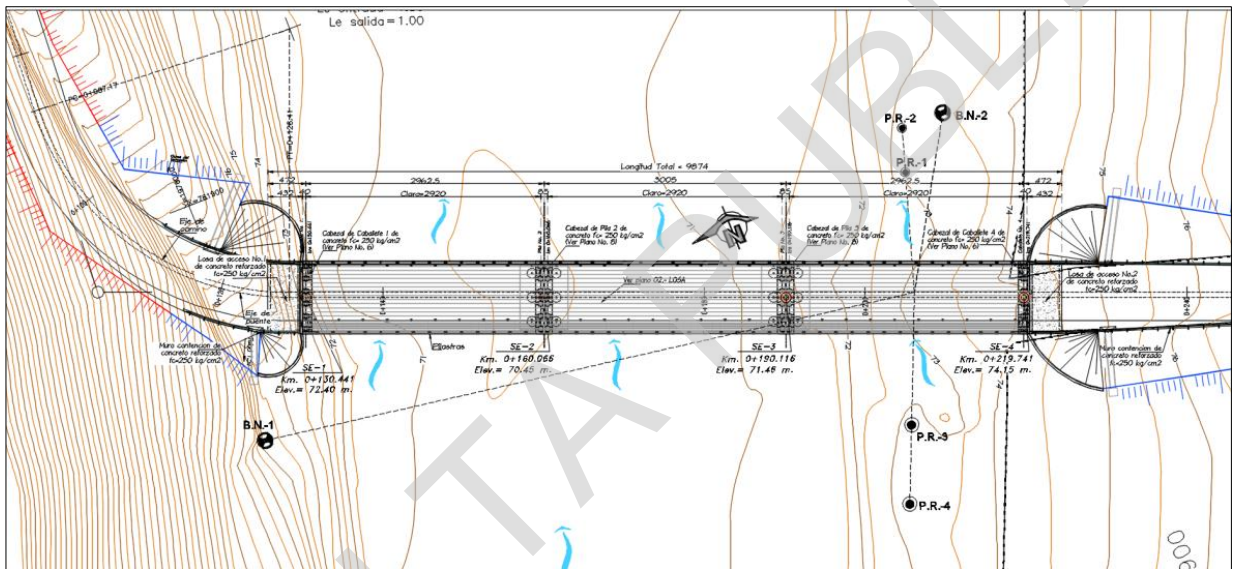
Planta general del proyecto de construcción del puente "Tlatepusco".
